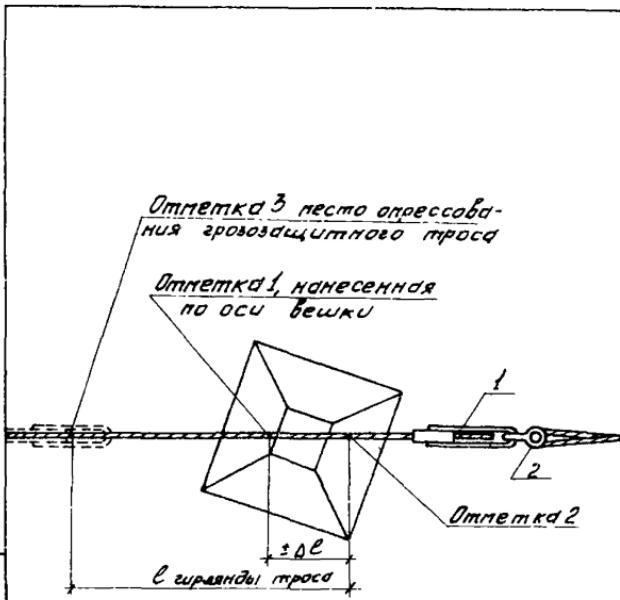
Схема нанесения отметок на заземляющем проводе при нивелировании по земле
